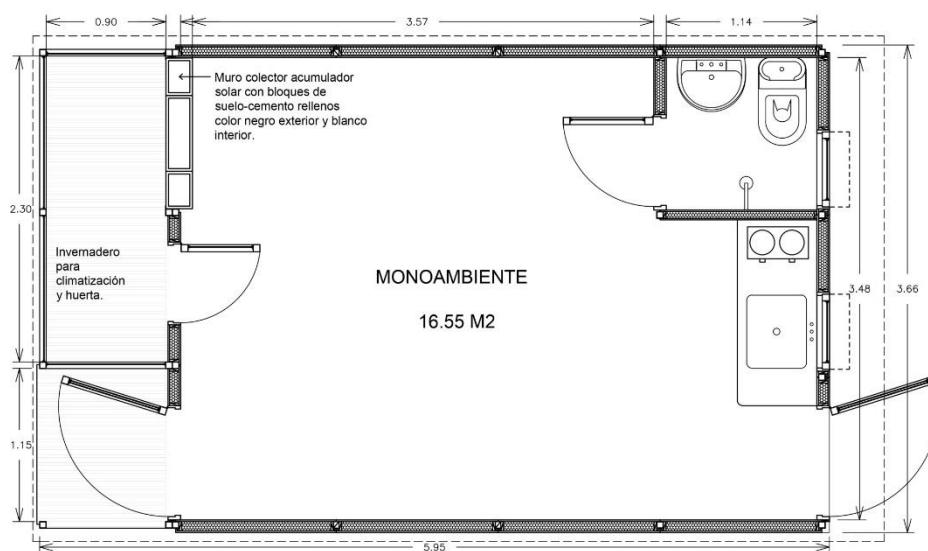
Planta del MOPES indicando equipamiento. Fuente: elaboración propia.
